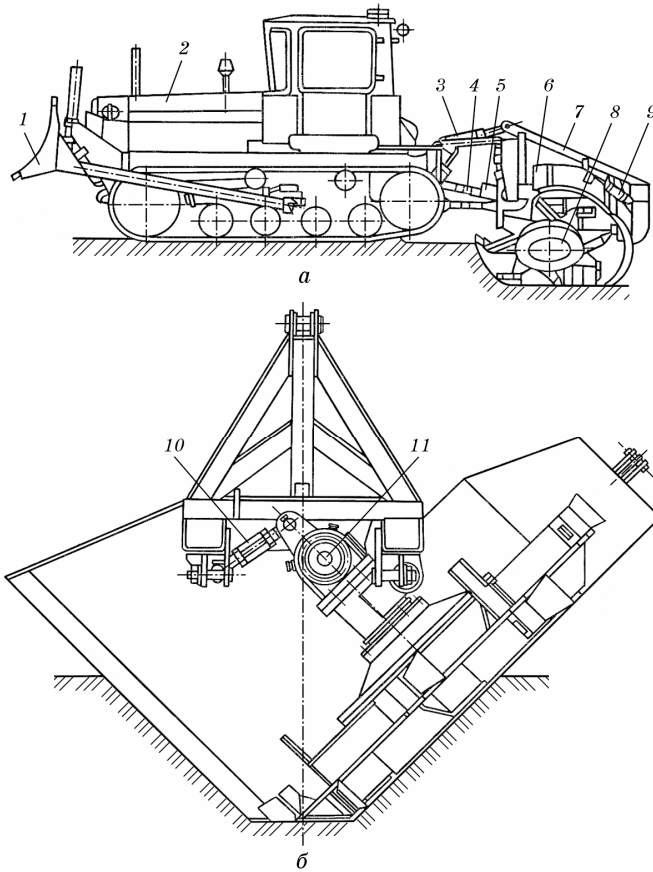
Схема плужно-фрезерного каналокопача МК-23:
